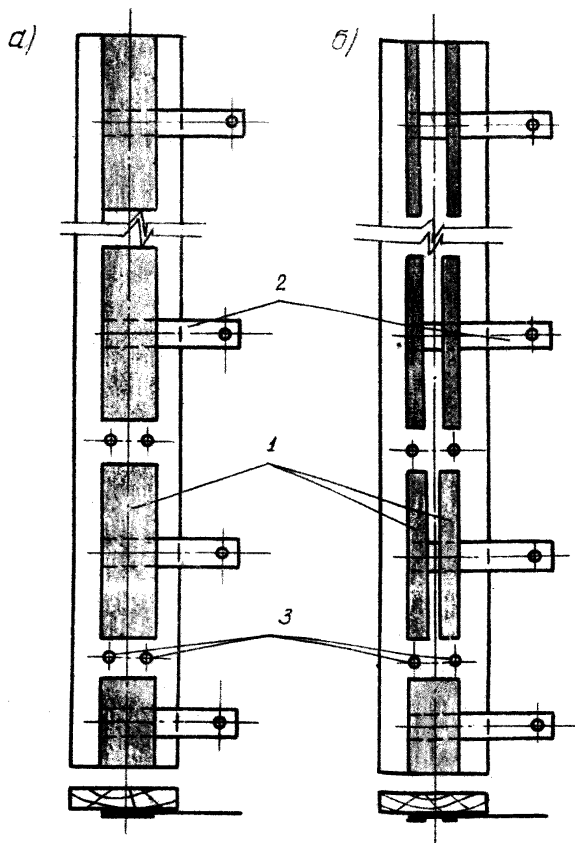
Схемы размещения электродов на оштукатурке стыков между стеновыми панелями:
